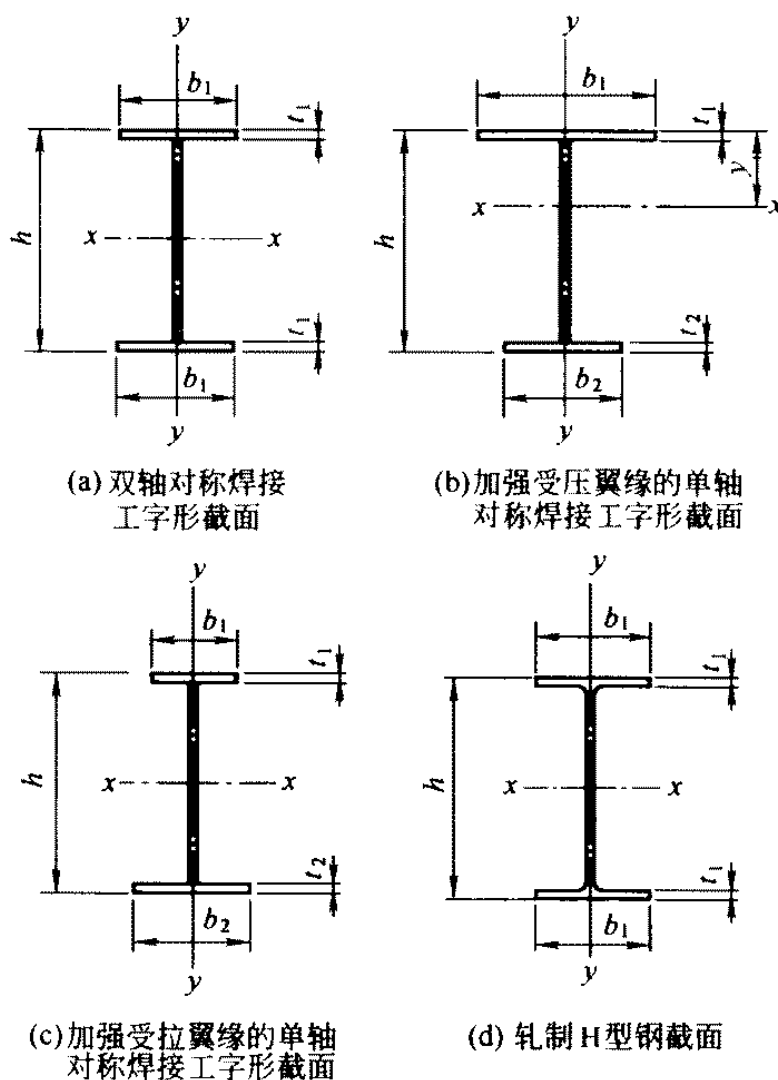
焊接工字形和轧制 H 型钢截面
